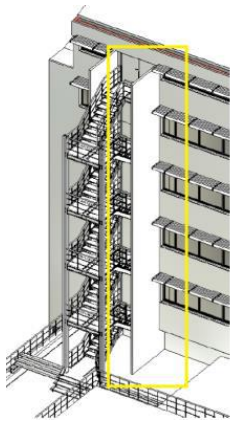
Fachada principal, Norte (OMATAPALO - Engenharia e Construção, 2022)
